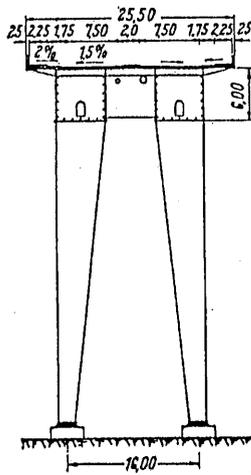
Projet 3.4. Coupe avec vue des béquilles
